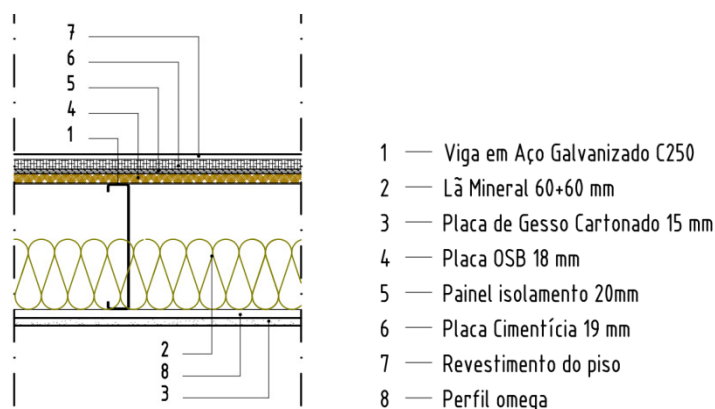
Esquema tipo de teto e pavimento entre fogos em estrutura leve em aço [15].
